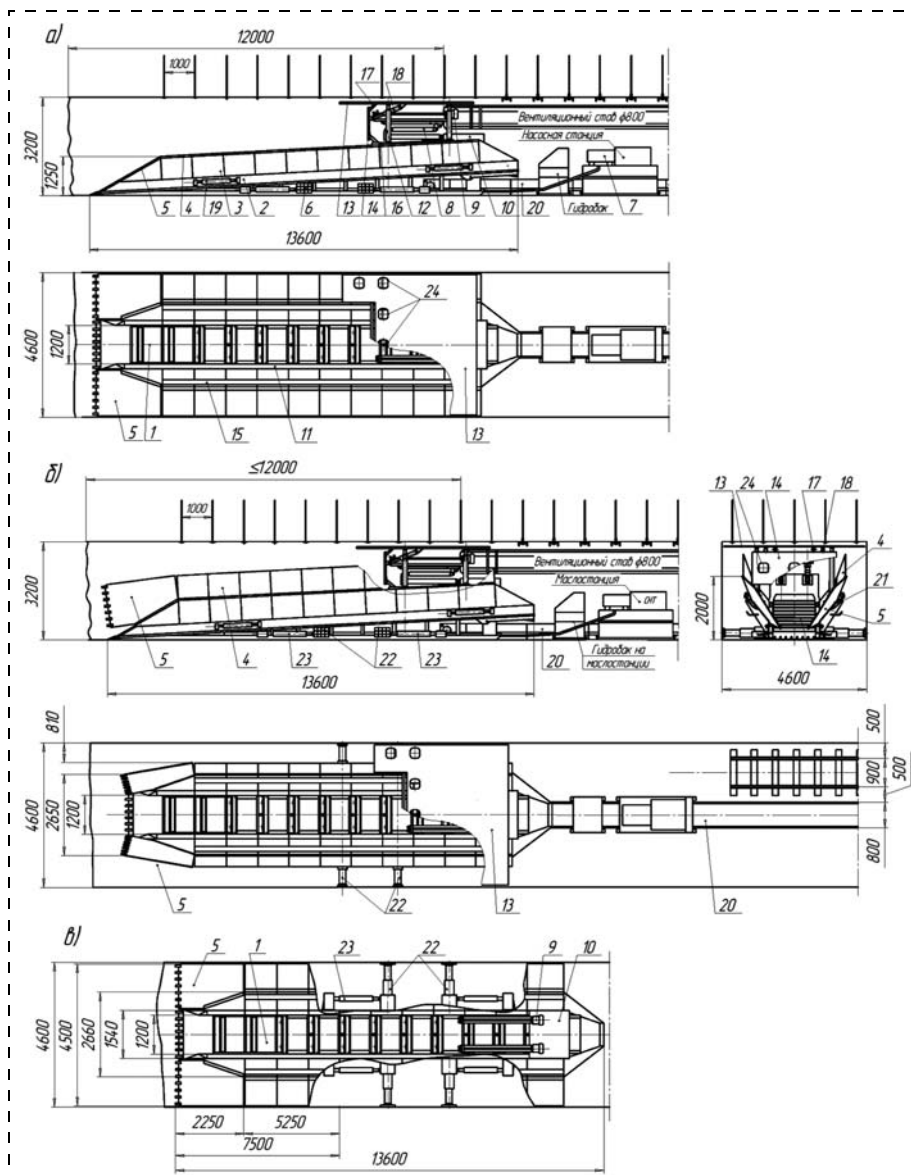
Агрегатированный проходческий взрывонавалочный комплекс ПКВН: а — расположение оборудования перед взрывными работами (борта опущены); б — расположение оборудования после выгрузки горной массы (борта подняты); в — расположение гидроцилиндров механизма самопередвижки
